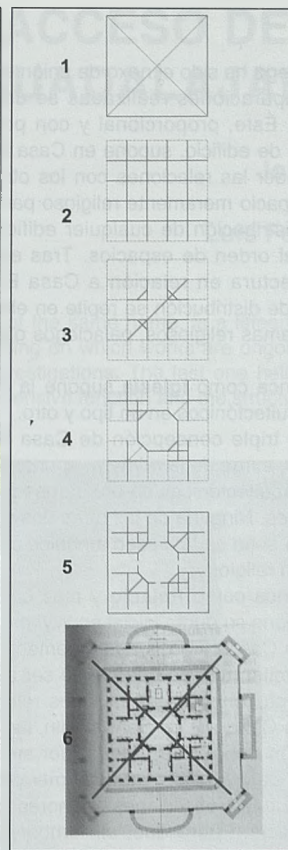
Esquema de la generación en planta de pabellón del Rey de Marly le Roi
